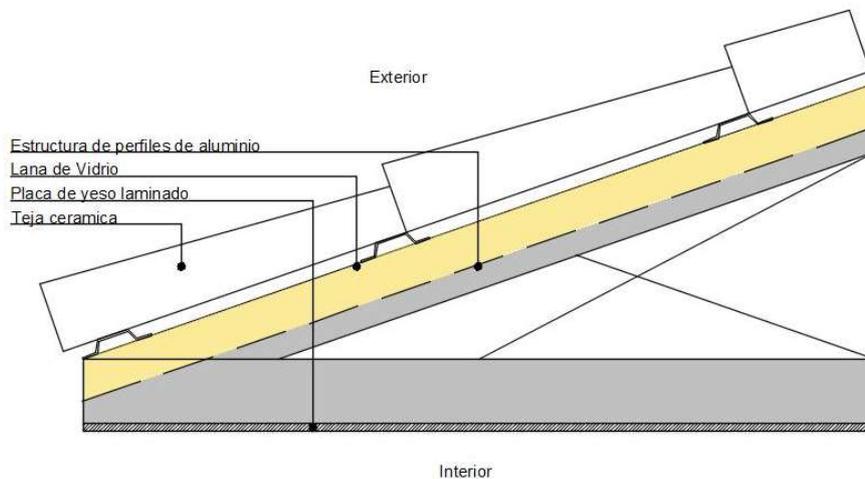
Detalle de cubierta con aislamiento. Sección longitudinal.
